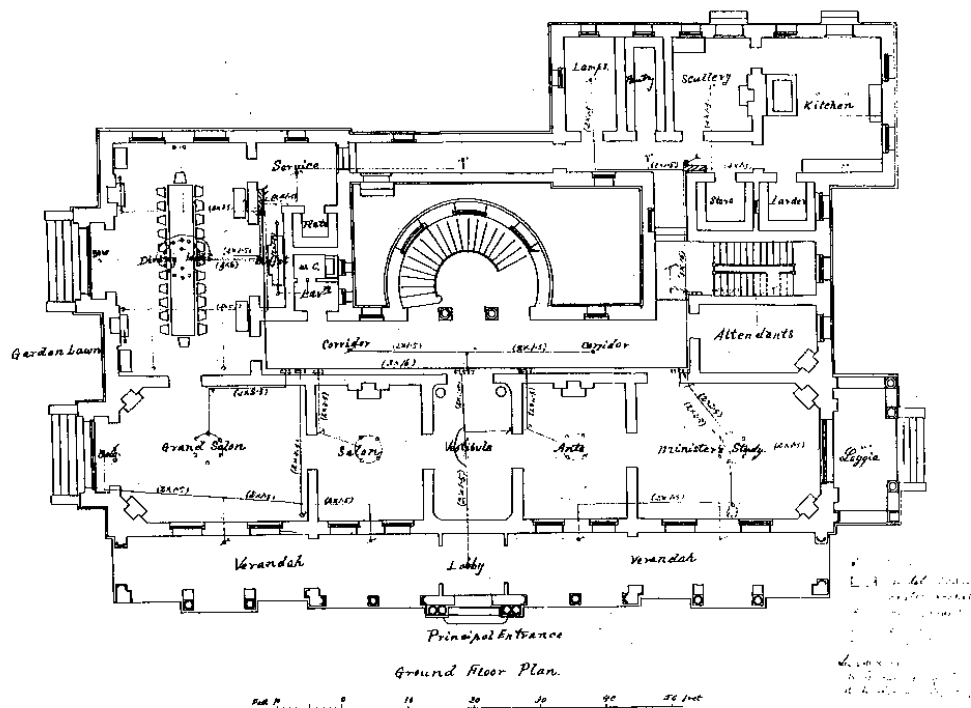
Grundriß des Gesandtschaftsgebäudes (Erdgeschoß)
